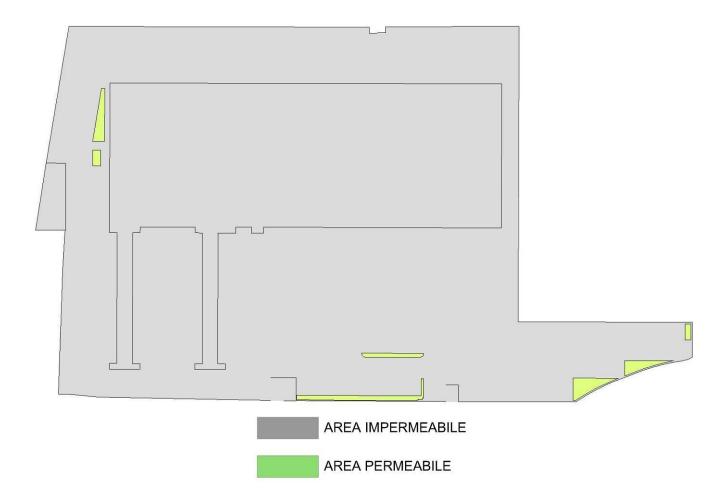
Carta tematica della permeabilità del sito nello STATO DI PROGETTO
